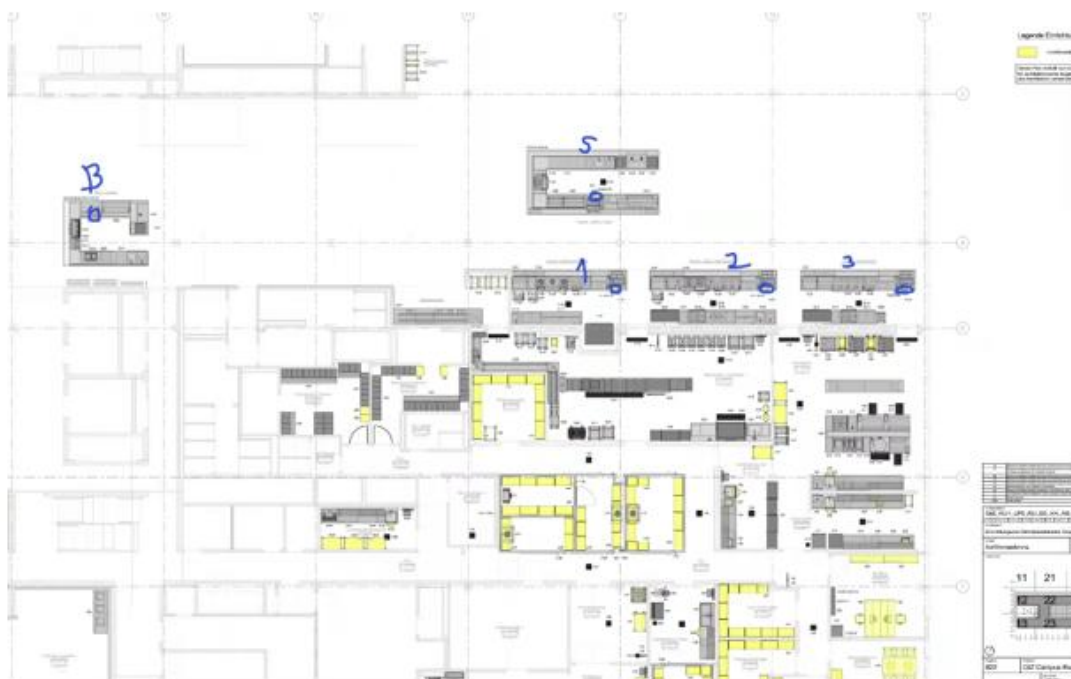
Grundriss-Übersicht mit Verortung der Kassenstationen 1, 2, 3, B und 5
